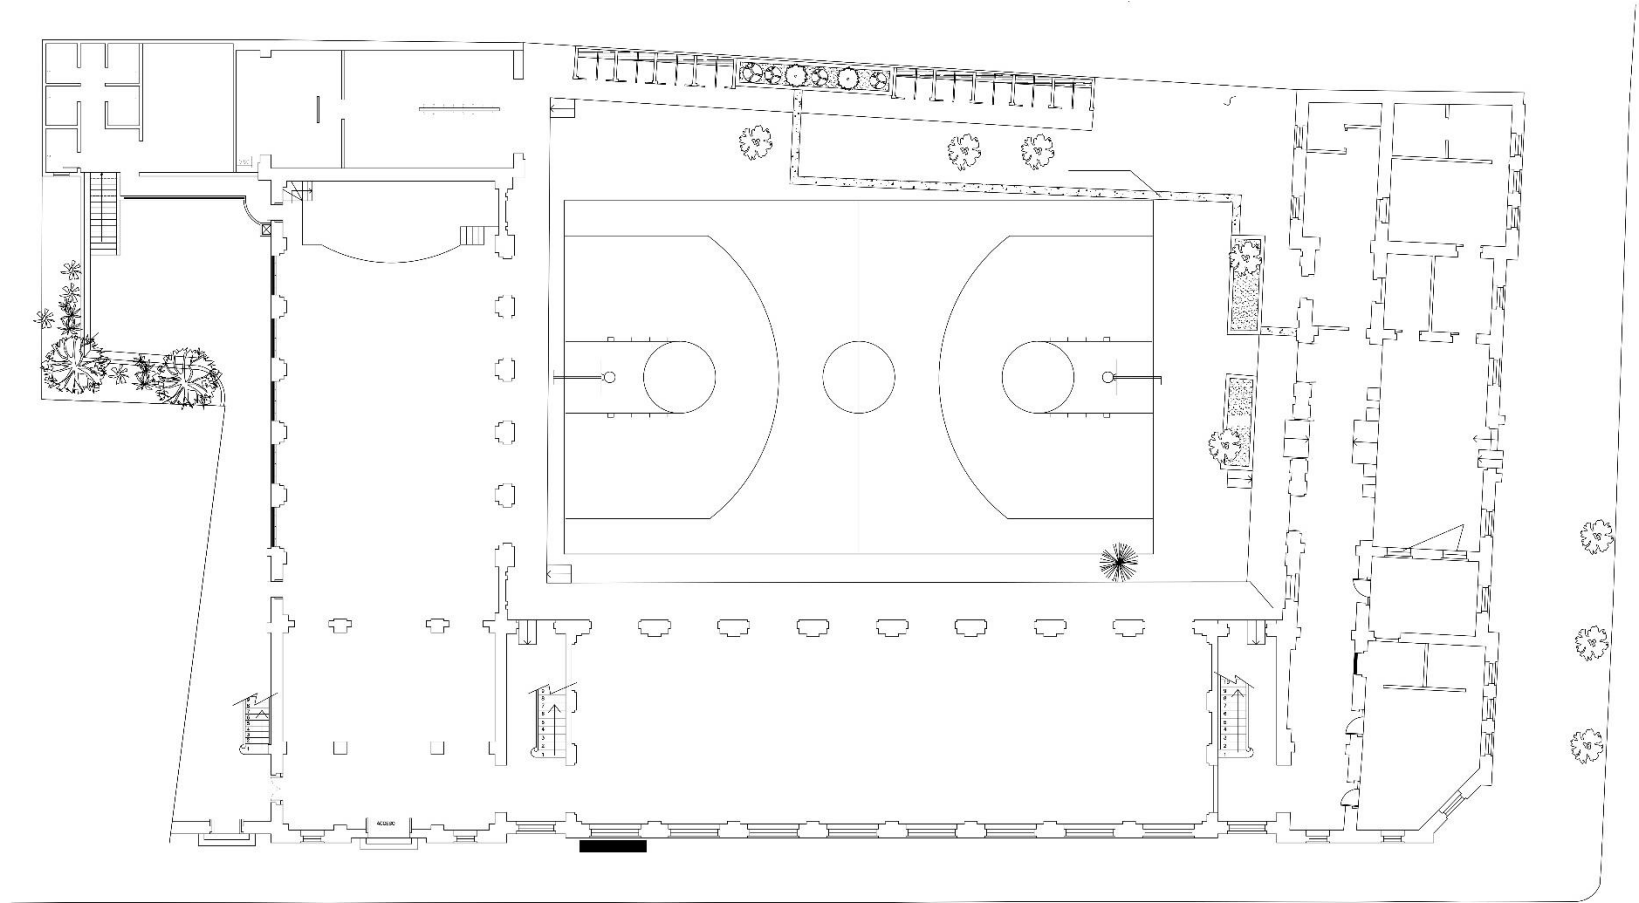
Planta Primer Nivel previo a la intervención. Fuente: Elaboración Propia
